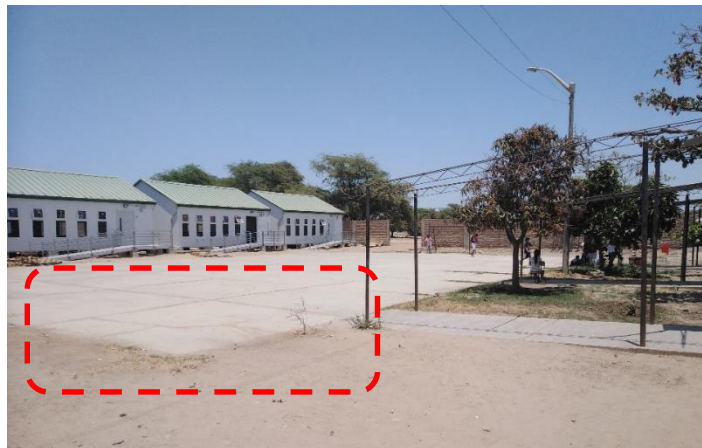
Se observa el Fisuramiento en el paño de la losa de concreto.
